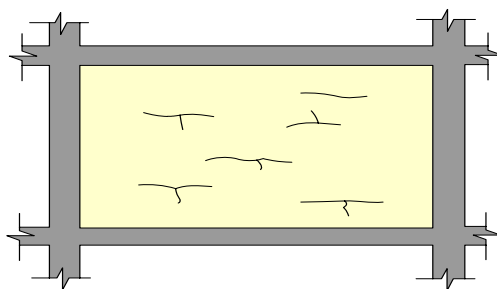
Trincas horizontais na alvenaria provenientes da expansão dos tijolos – Adaptada de THOMAZ, 1996
